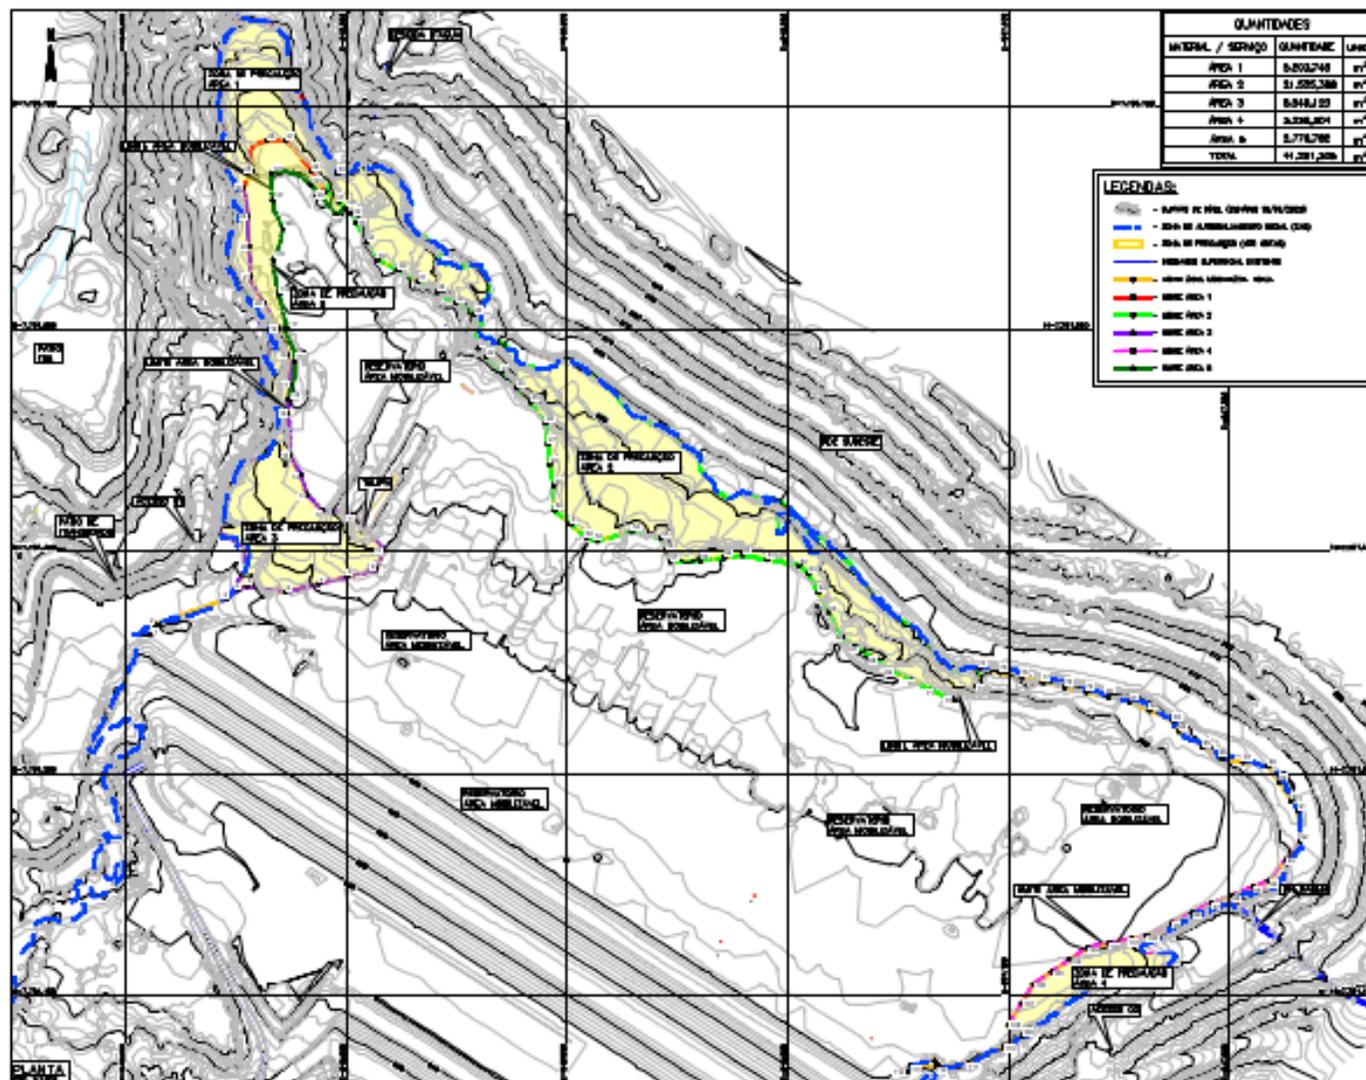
Planta de avaliação da área mobilizável e de precaução da Barragem Sul Superior.
